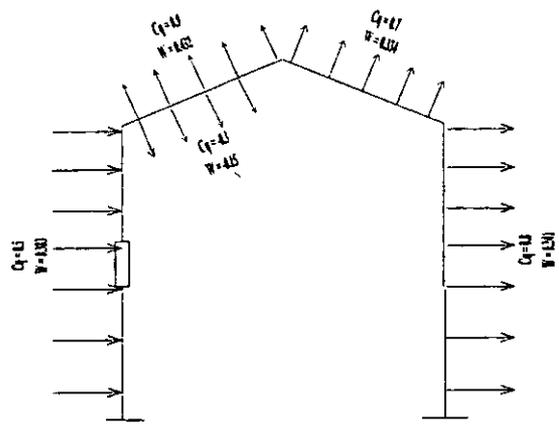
VIENTO TRANSVERSAL SUR-NORTE
